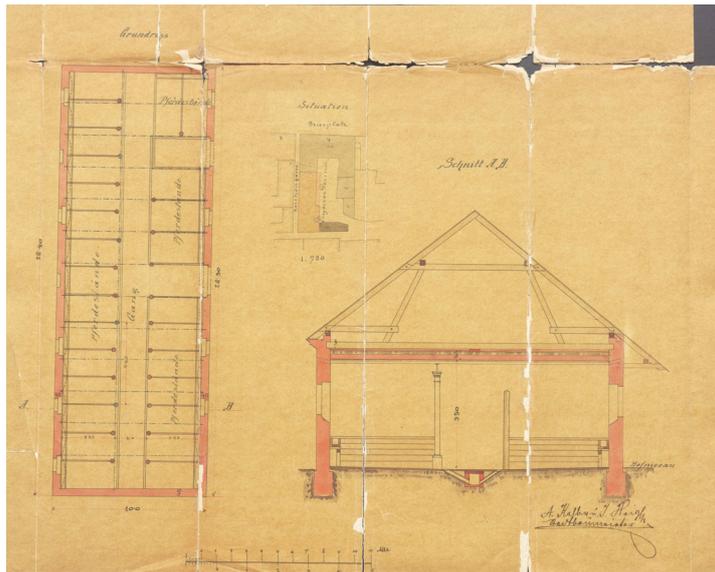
Plan des eingeschossigen Hofgebäudes von 1887,
